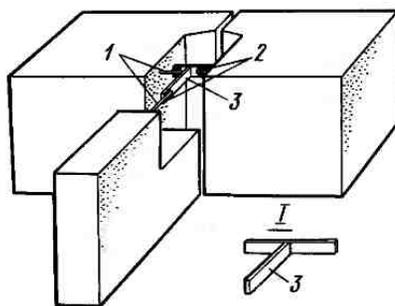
Соединение стеновых панелей с помощью сварного стального анкера-связи:
